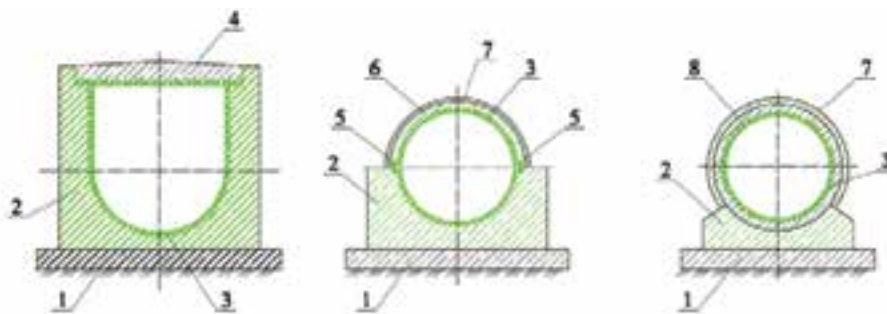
Коллекторы, выполняемые открытым способом: 1 — подготовка; 2 — бетон с добавкой MasterGlenium®; 3 — гидроизоляционные составы MasterSeal® 531 или MasterSeal® 588; 4 — железобетонная плита; 5 — набухающая паста MasterSeal® 912; 6 — железобетонный свод из бетона с добавкой MasterGlenium®; 7 — бетонный слой (с добавкой MasterGlenium®) для заделки стыков свода; 8 — железобетонная труба
